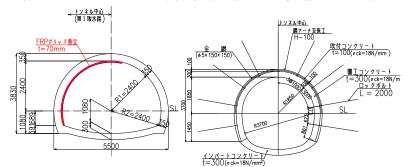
新設取水路トンネル 既設取水路トンネル 図-1 断面図 断面図
